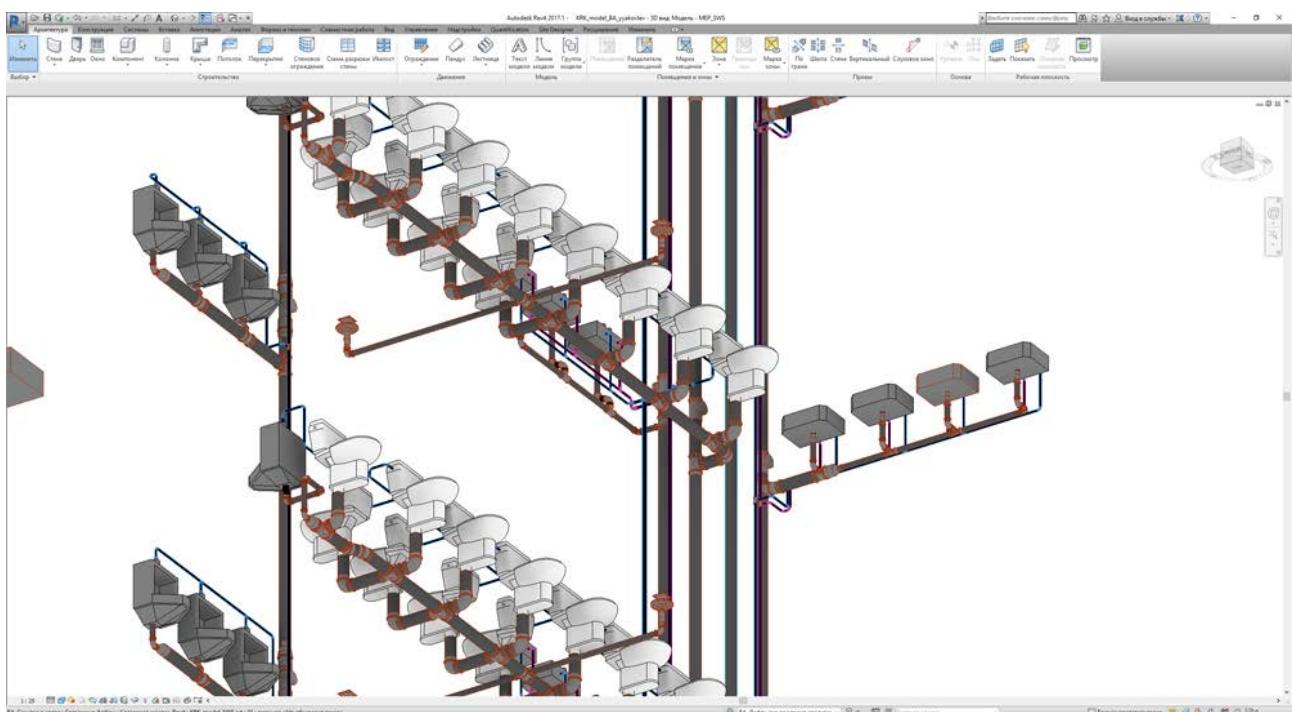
BIM-проектирование. Часть системы водоснабжения и отведения стоков здания, представляемая в отдельном окне без строительных конструкций
